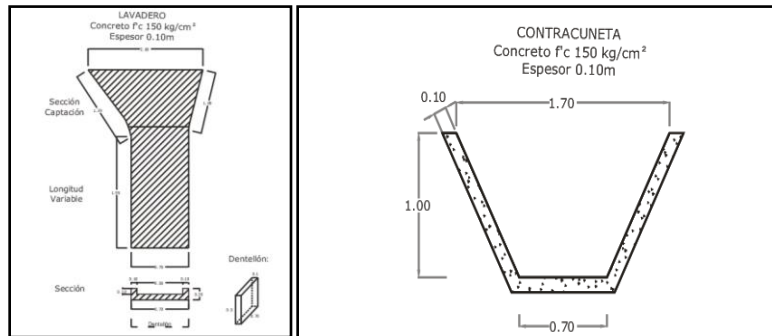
Sección tipo de las obras de drenaje complementarias.
